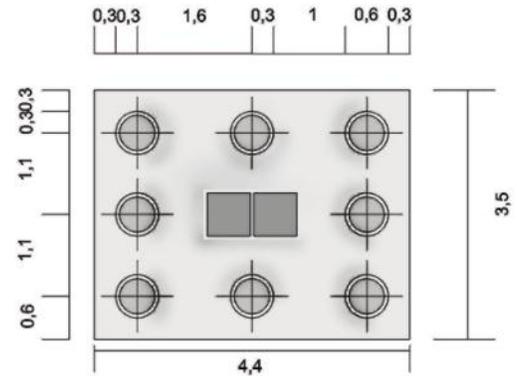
Detalle en Alzado Sistema de Cimentación
